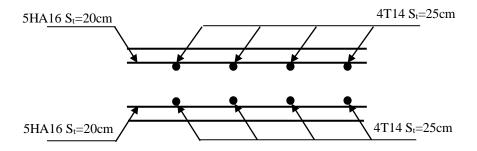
Vue en coupe du ferraillage de la dalle.
